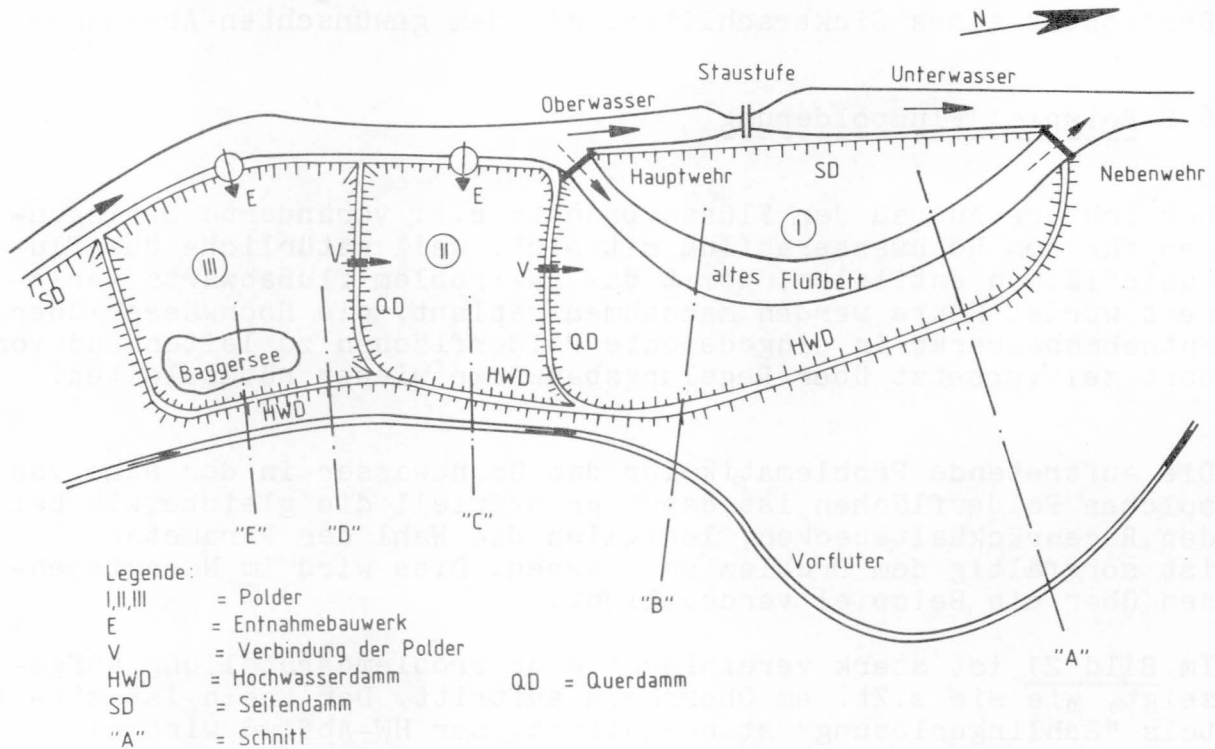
Lageplan eines Hochwasserrückhaltesystems an einem staugeregelten Fluß
